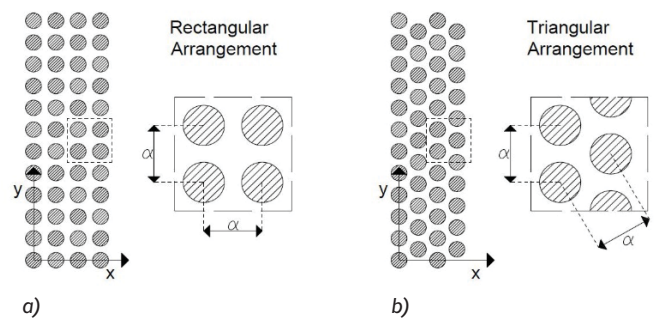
Differenti disposizioni geometriche in pianta: disposizione rettangolare a) e triangolare b)
